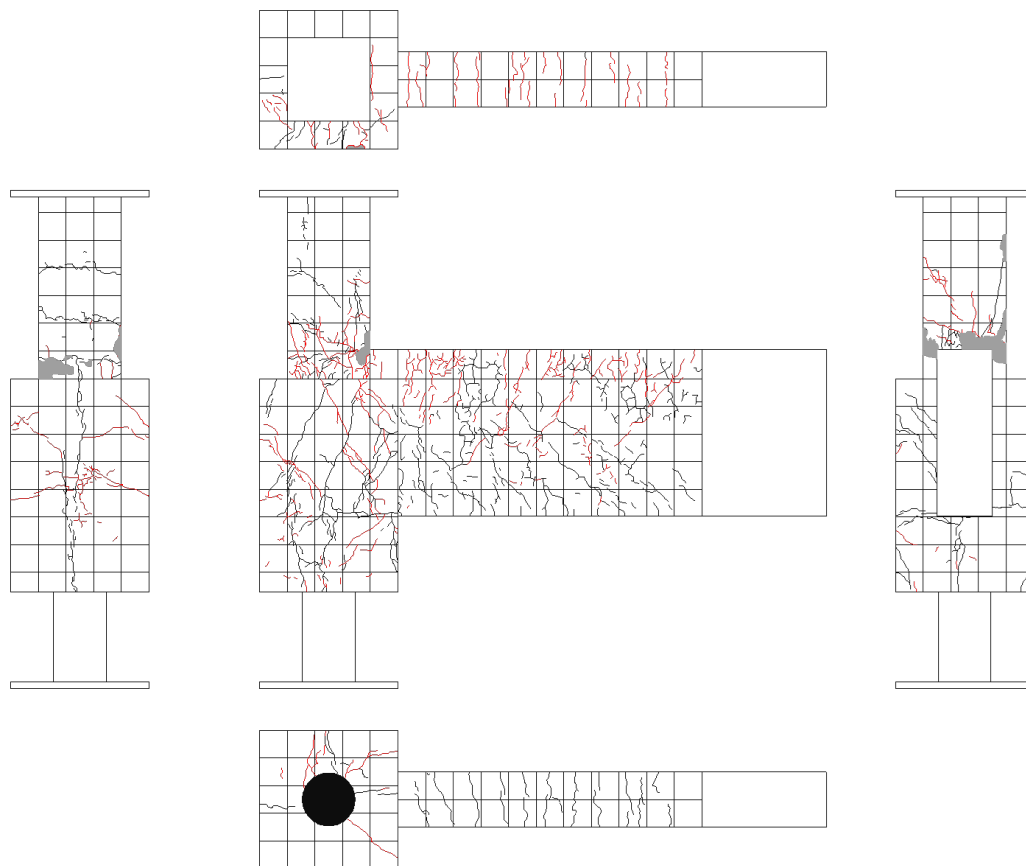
試験体 A-7b ひび割れ状況 (7Cycle)
